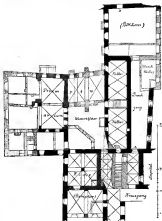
Grundriss des Palais de l'Horloge von der Wasserleitung
